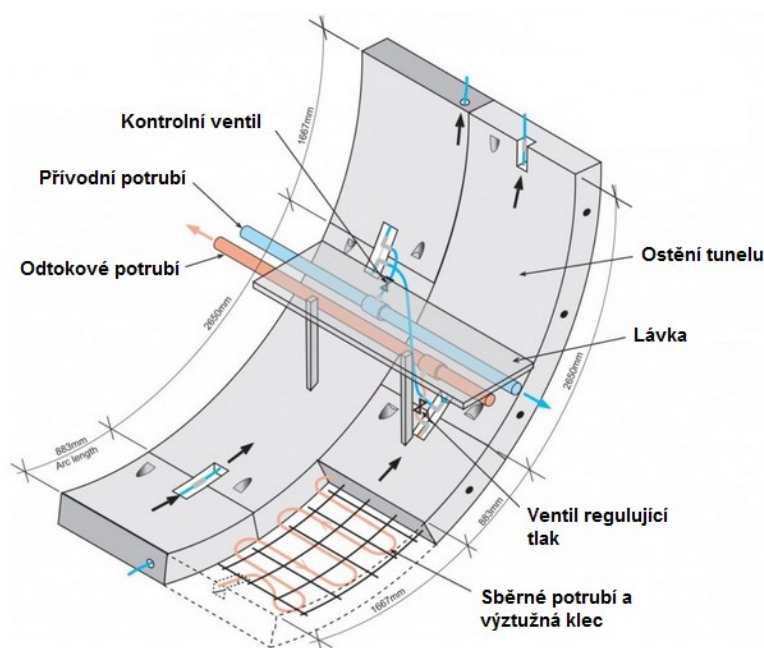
Uchycení potrubního systému tepelného výměníku na výztužnou klec prefabrikovaného segmentu.
